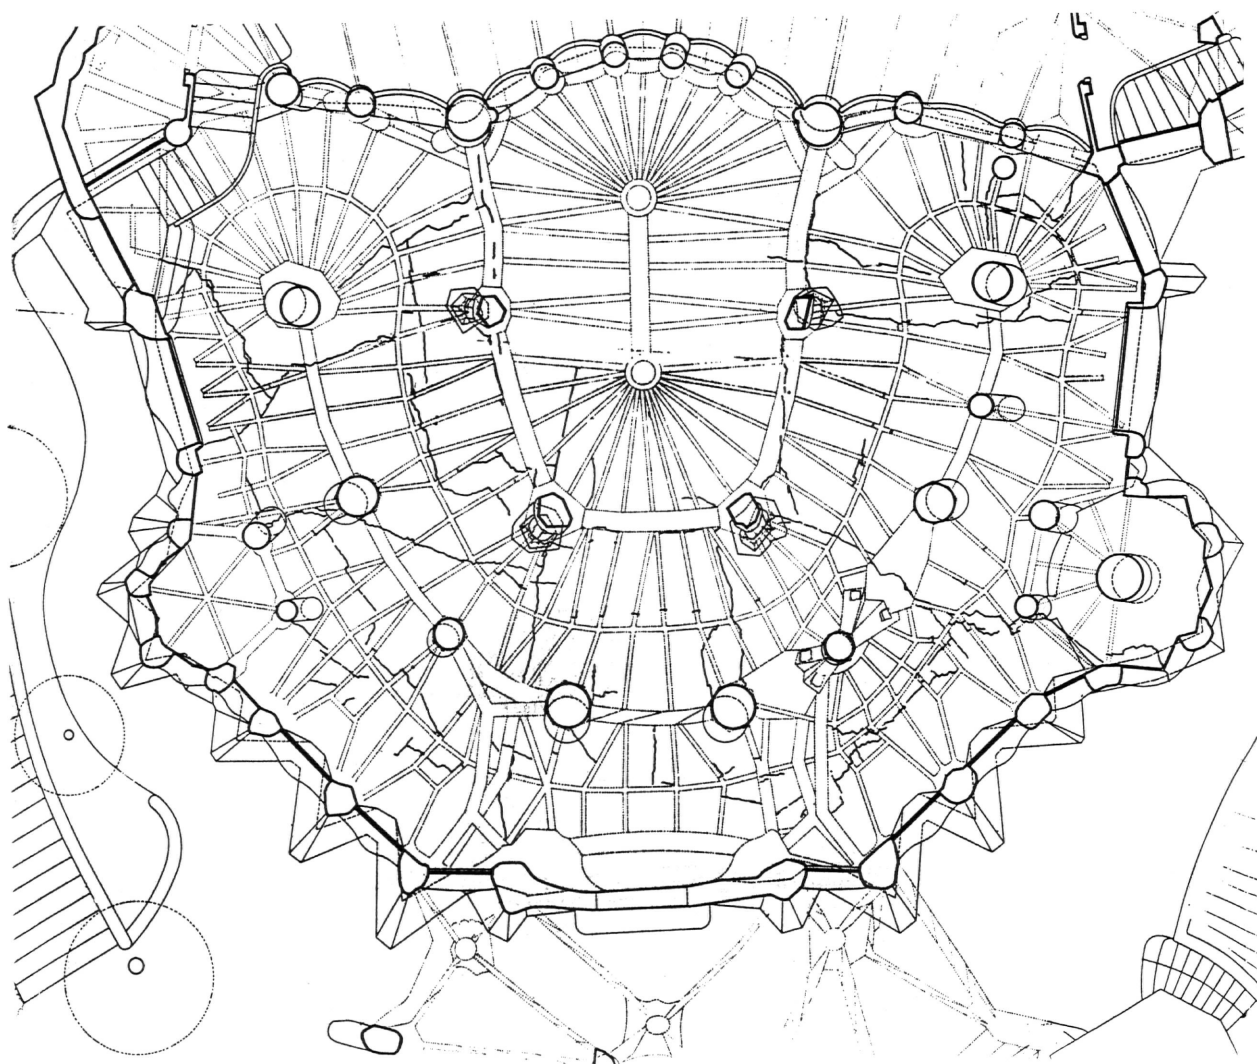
Planta cenital de la capilla con las fisuras que afectan tanto al tablero tabicado como a las costillas.
